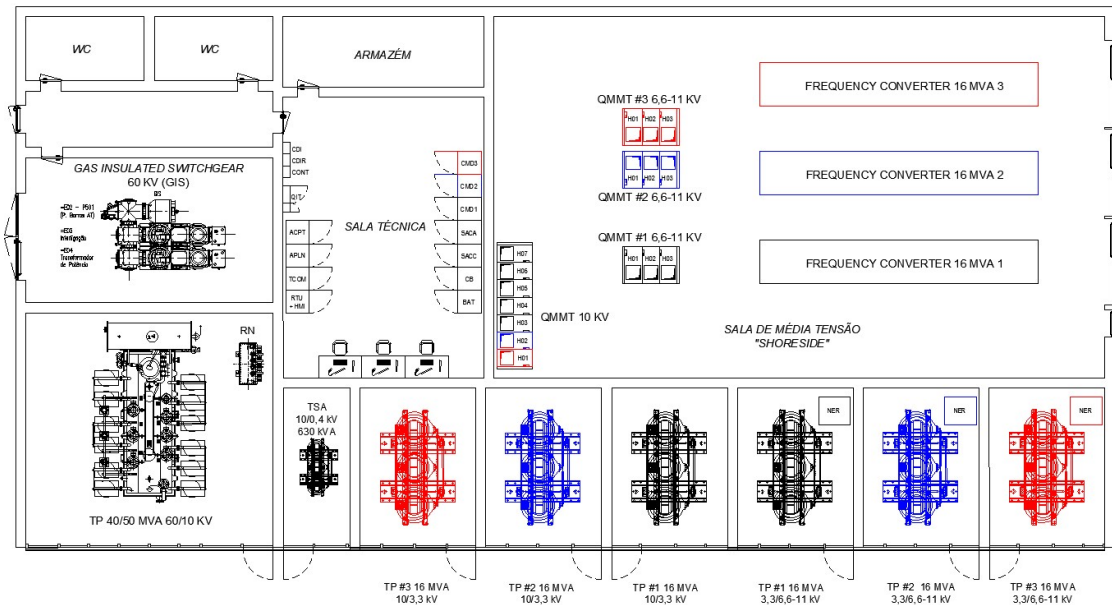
Disposição em planta dos equipamentos da Subestação Principal
